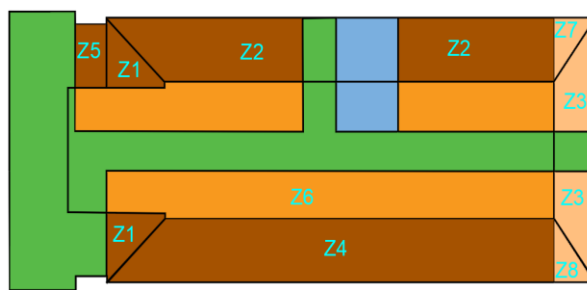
Zonas térmicas do terceiro pavimento. Em verde: circulação; em azul: instalações sanitárias; em laranja: zona interna; em marrom: zonas perimetrais; em marrom claro: zonas perimetrais sobre o solo (Fonte: Elaborado pelos autores, 2022).
